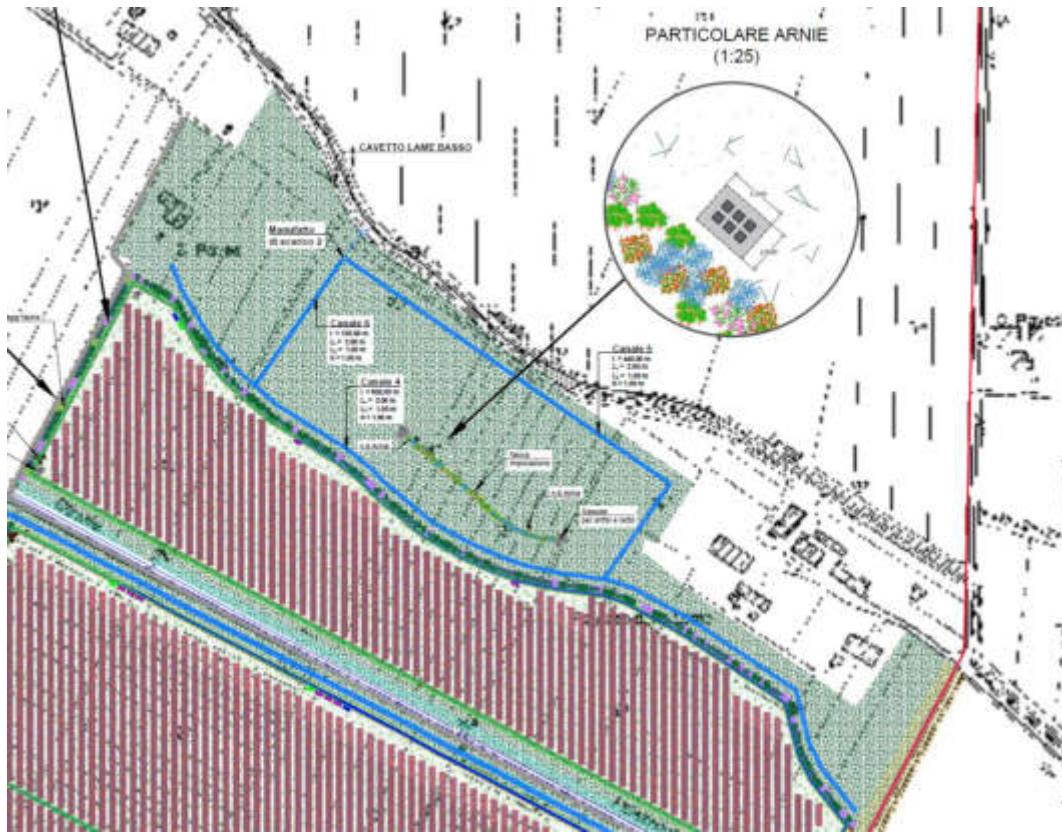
Localizzazione arnie (stralcio layout di impianto)
